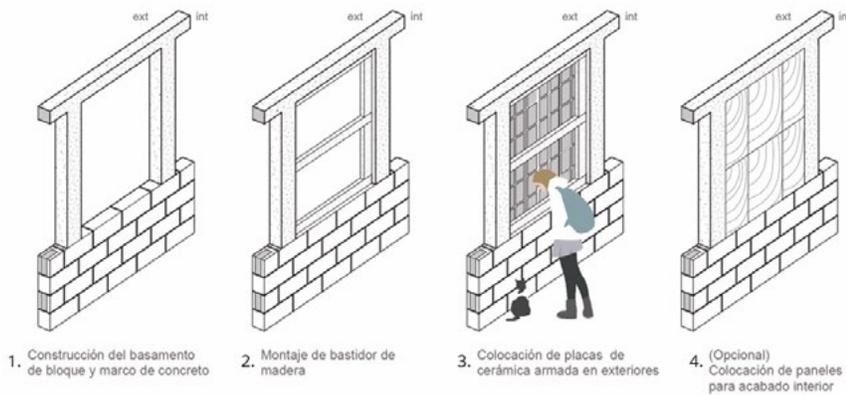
Montaje de las placas prefabricadas sobre zócalo de bloque de concreto y marco de hormigón armado embebido en el mismo (fuente: Elaboración propia, 2018).
